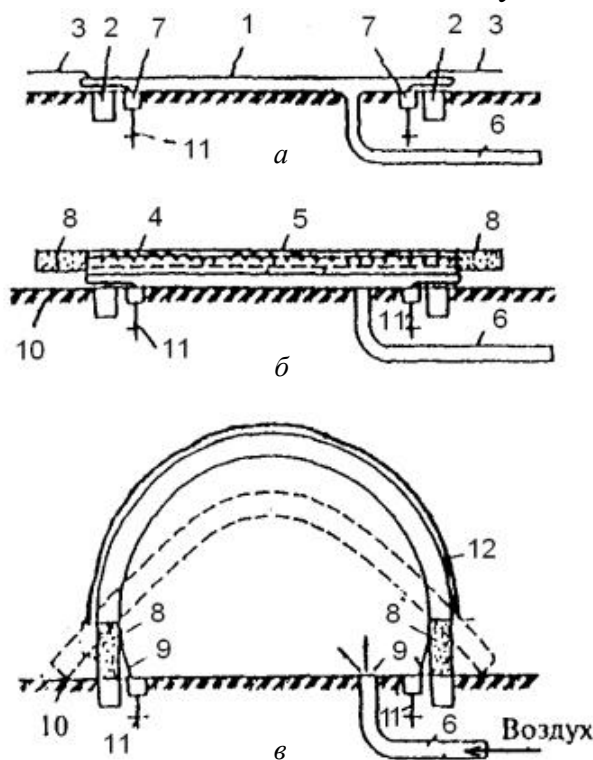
Пневмоопалубка: *а* – подготовленная опалубка; *б* – опалубка с уложенной бетонной смесью; *в* – поднятая опалубка; 1 – пневмоопалубка; 2 – фундамент; 3 – открьлки; 4 – спиральная арматура; 5 – бетонная смесь; 6 – трубопровод для нагнетания воздуха; 7 – опорные трубы; 8 – участки свода (стены), бетонированные заранее; 9 – участки пневмоопалубки, не соприкасающиеся с бетоном; 10 – фундамент; 11 – анкеры; 12 – натяжная внешняя оболочка
